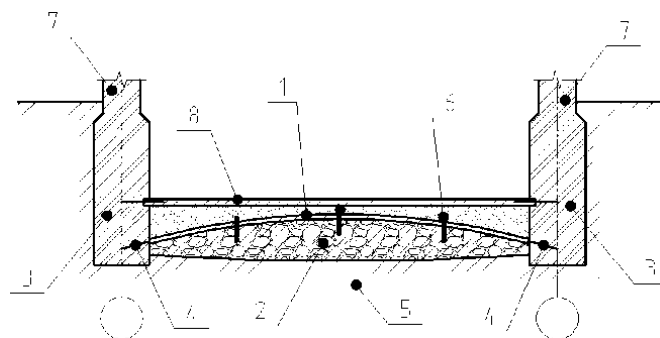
Технологічна схема перевлаштування стрічкових фундаментів у плиту змінної жорсткості з переднапруженою ґрунту: 1 - ж/б оболонка; 2 - щебенева подушка з нагніченим розчином; 3 – стрічковий фундамент; 4 – анкер; 5 - переднапружена основа; 6 – ін'єктори; 7 – існуючі стіни; 8 - силова підлога
